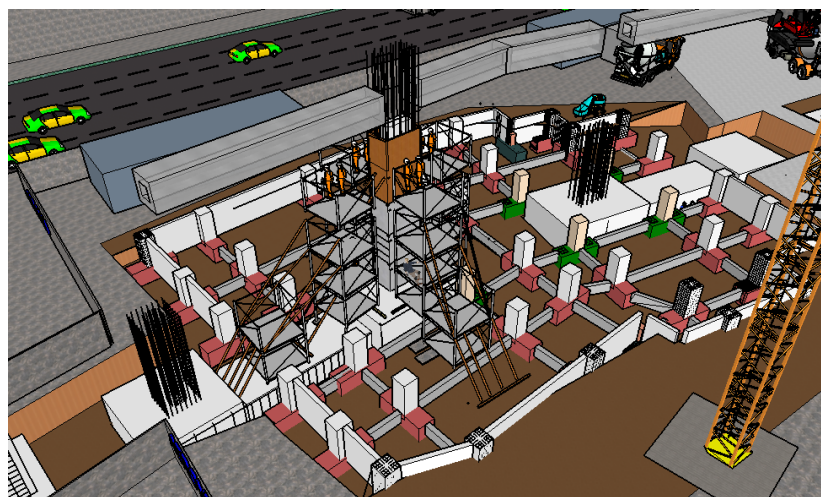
Fundición de columna hasta 1 metro inferior al nivel de la viga riostra
